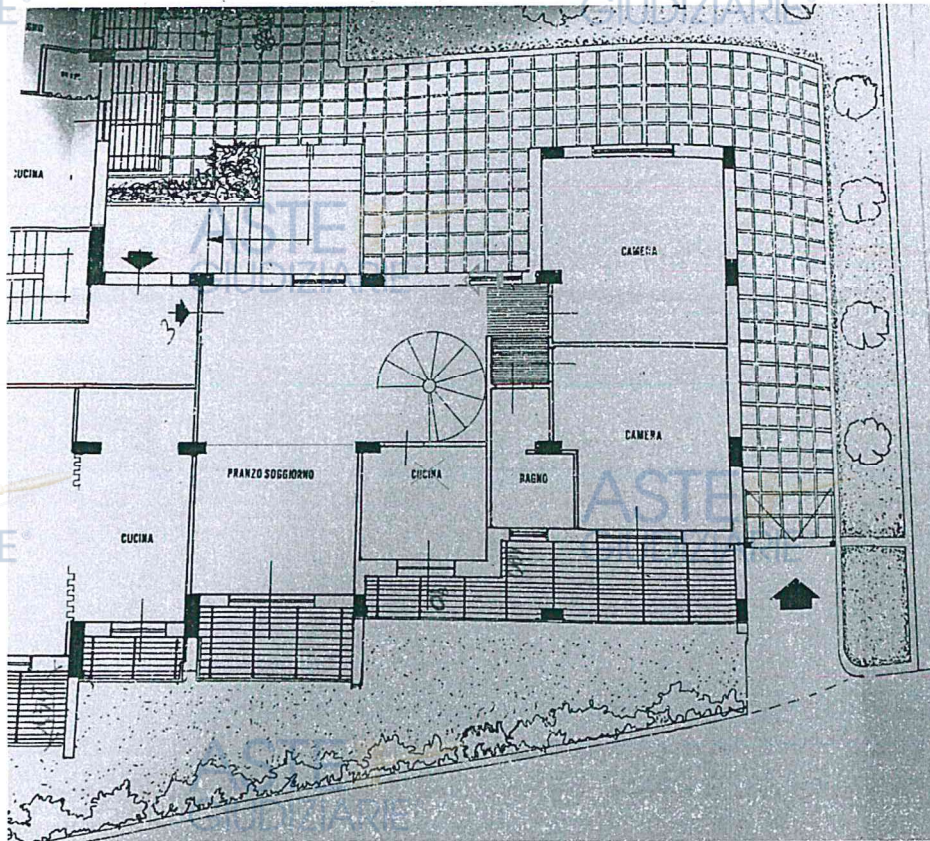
Elaborato grafico relativo alla Concessione Edilizia in variante del 19/12/1993 – Planimetria appartamento piano rialzato. Si evidenziano le difformità rispetto lo stato dei luoghi.
